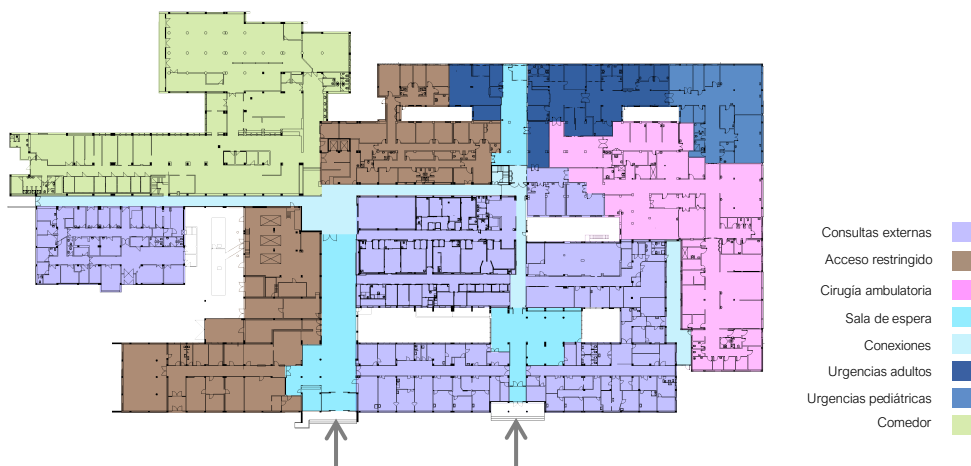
Planta baja bloque 7. Análisis de distribución de áreas. Plano base oficial facilitado por el Ingeniero Paulo Costa. Análisis gráfico realizado por Laura Castro.
